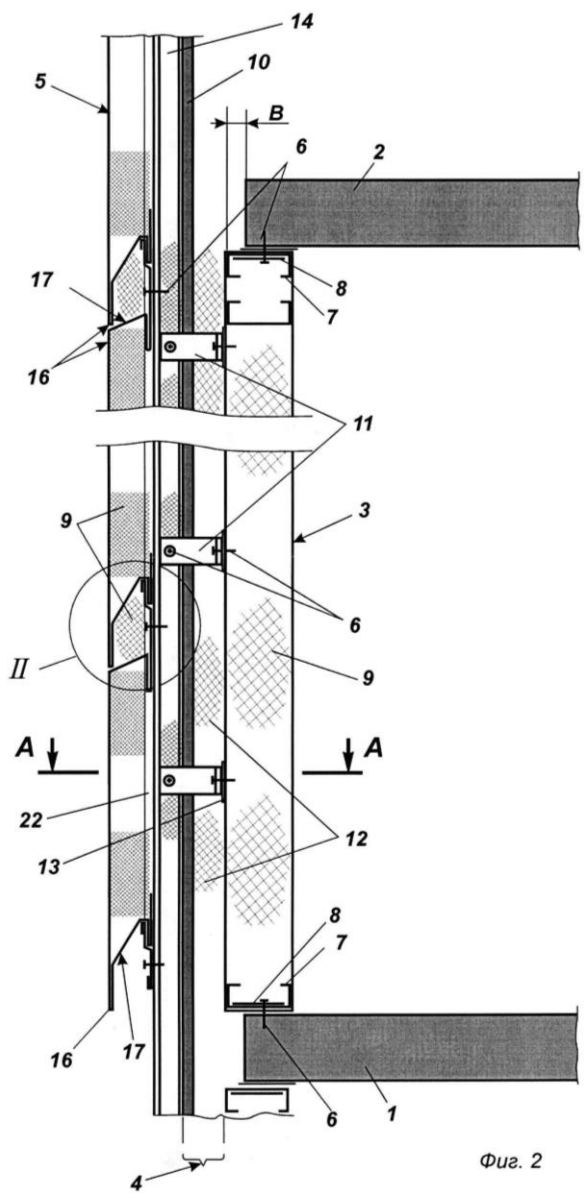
Структура фасадной системы здания на фрагменте вертикального разреза здания с облицовочным слоем наружной стены, выполненным из сайдинга [6]
